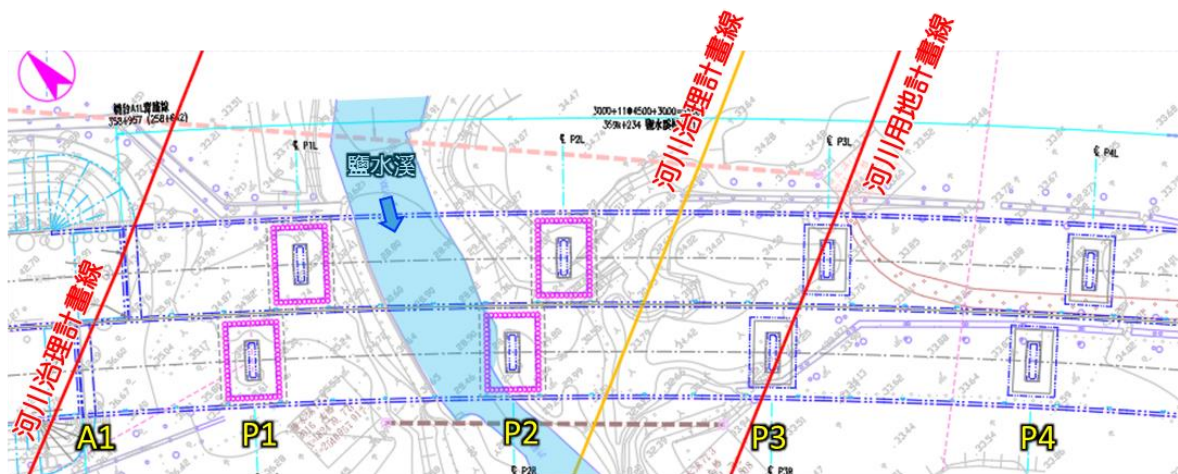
鹽水溪河川橋 P1~P4(北、南)平面圖
